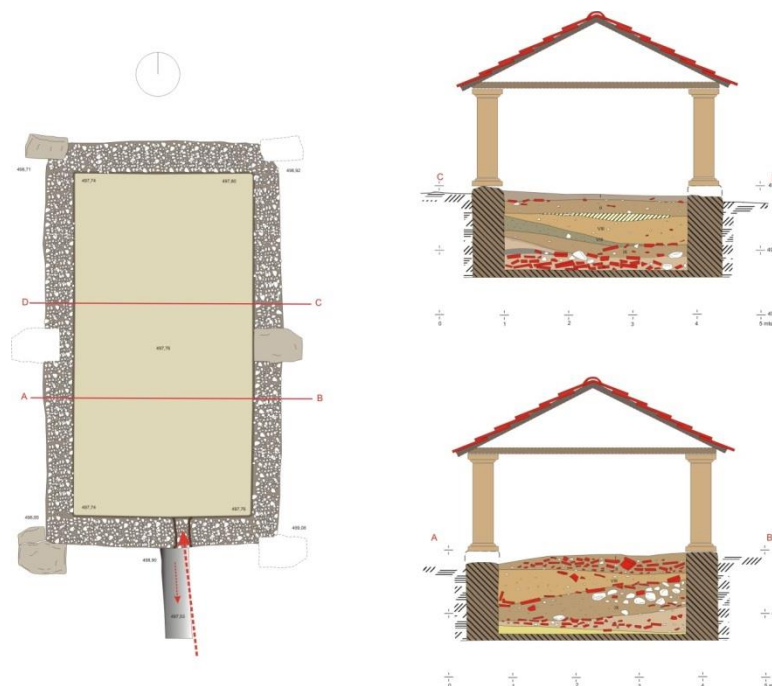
Planta y sección reconstruida de la balnea c.e. 155 (Imagen: J.L. Serrano).
